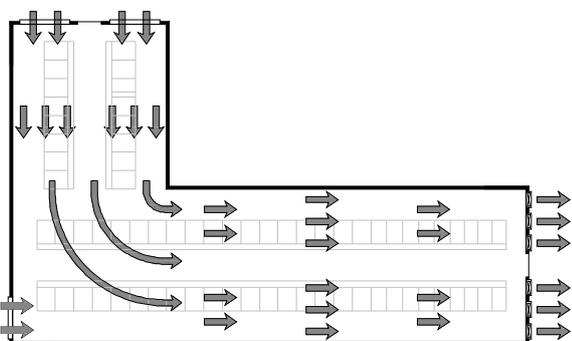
configuration idéale pour l'installation d'un système de ventilation longitudinale.
